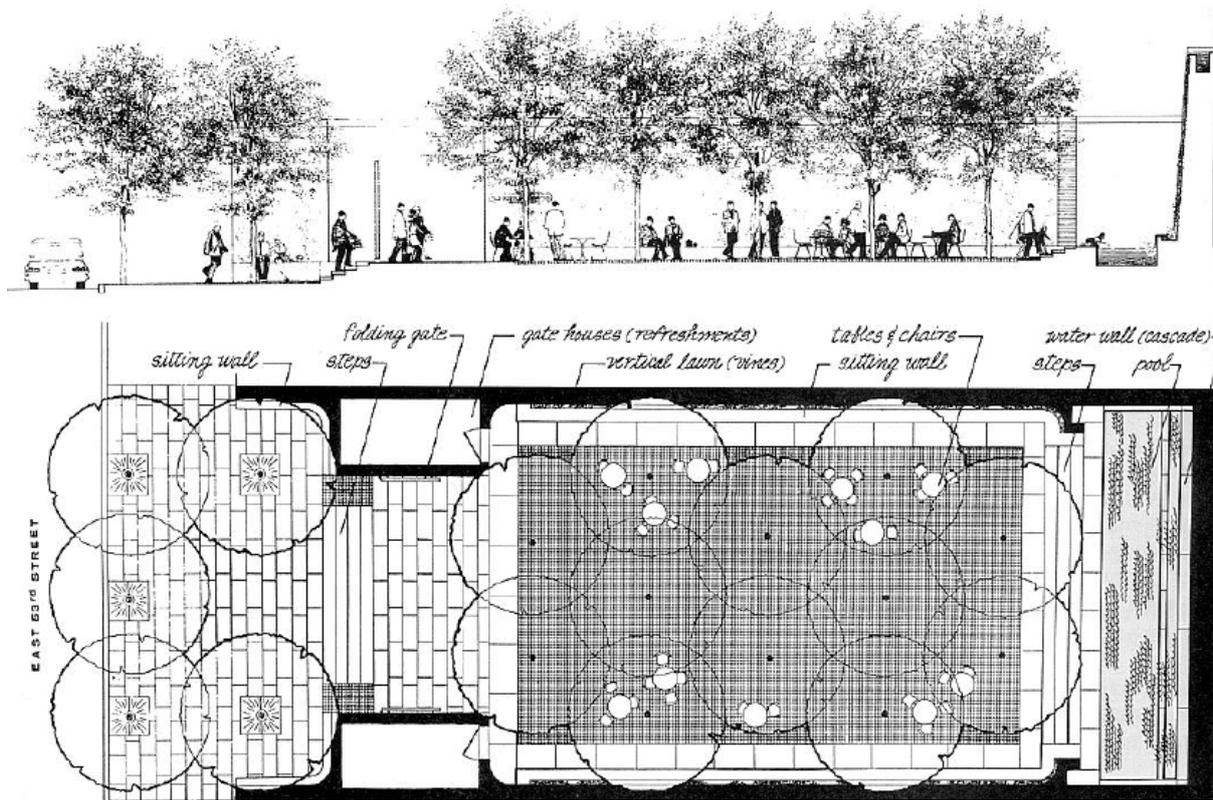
Planta baixa do Paley Park, NY. Fonte: http://Isa496696.weebly.com/uploads/2/9/4/5/29457247/05.12_monday_paley_park.pdf
